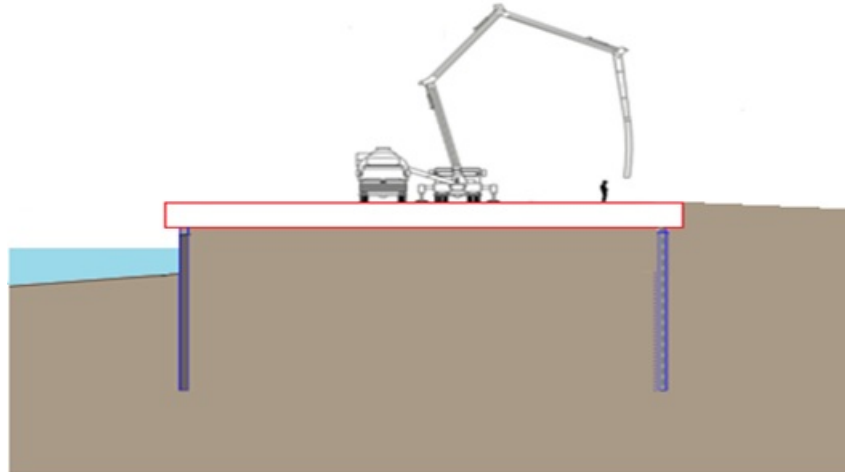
Esecuzione trave di coronamento e pavimentazione
